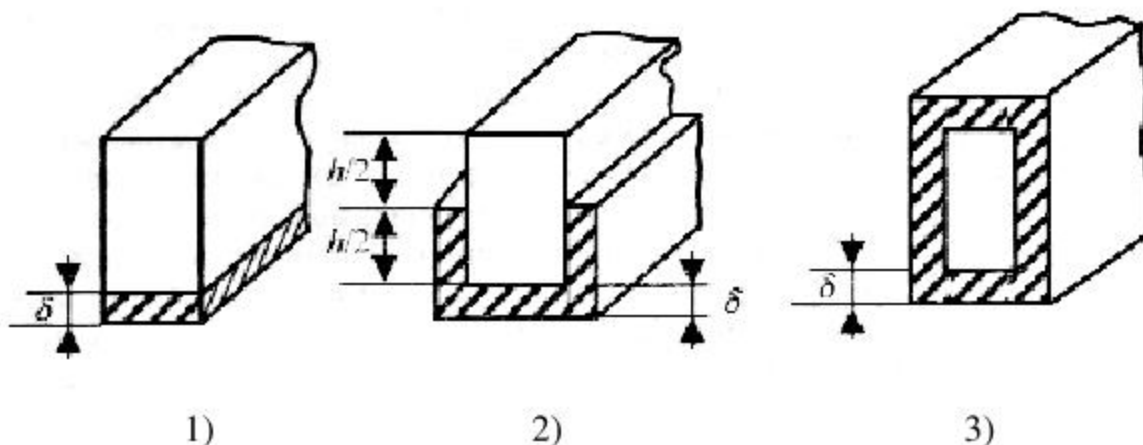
Схема підсилення залізобетонних балок: 1 – нижня розтягнута грань балки; 2 – розтягнута зона до осьової лінії; 3 – у вигляді обійми.
